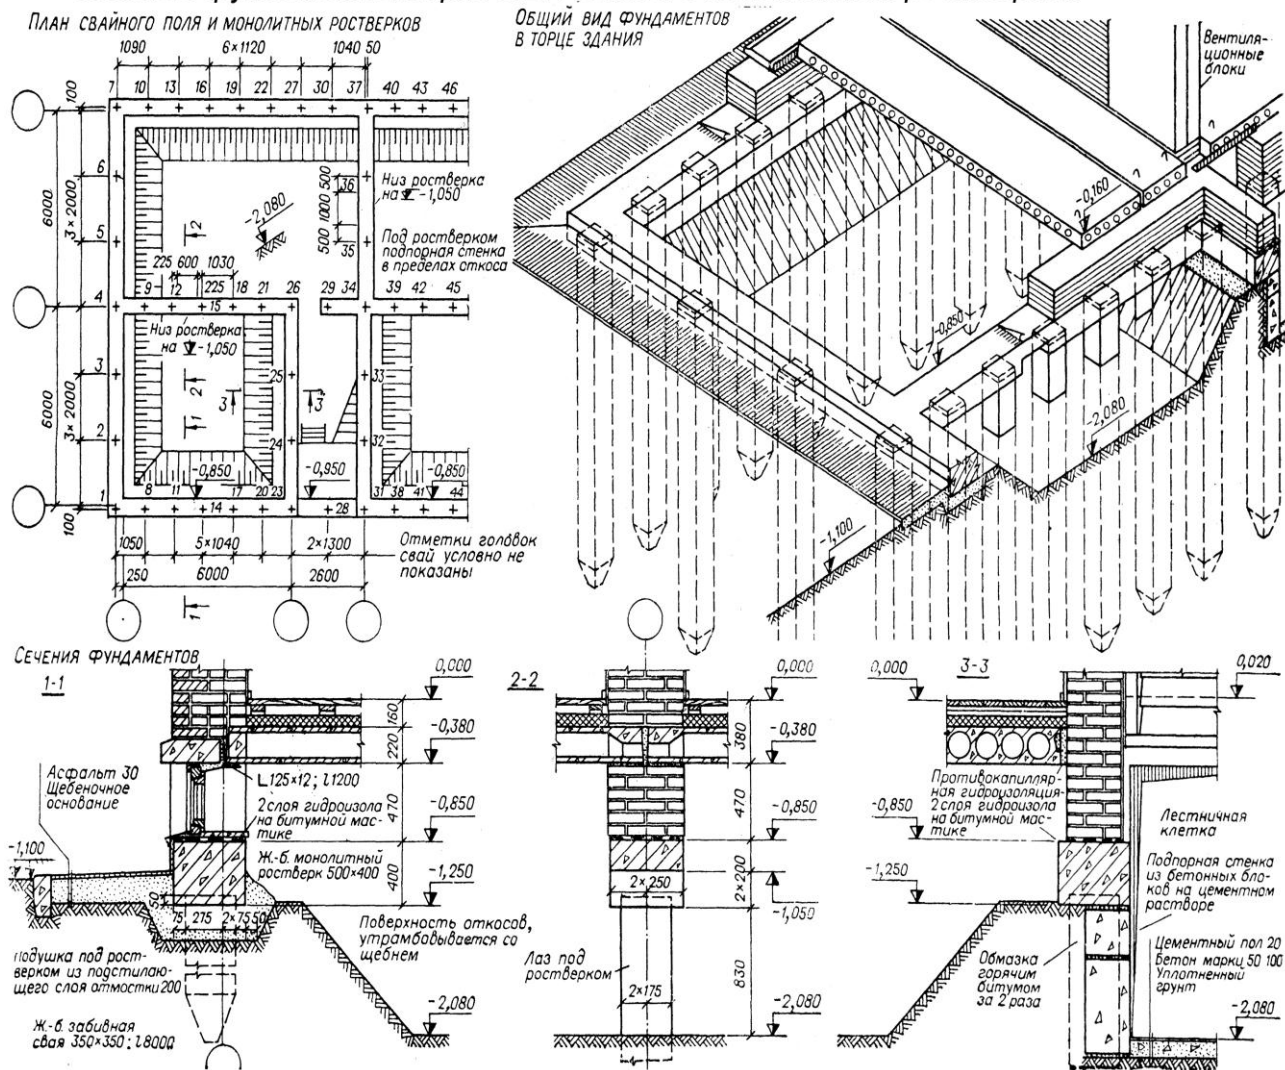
Сечения свайных фундаментов с монолитным ростверком
